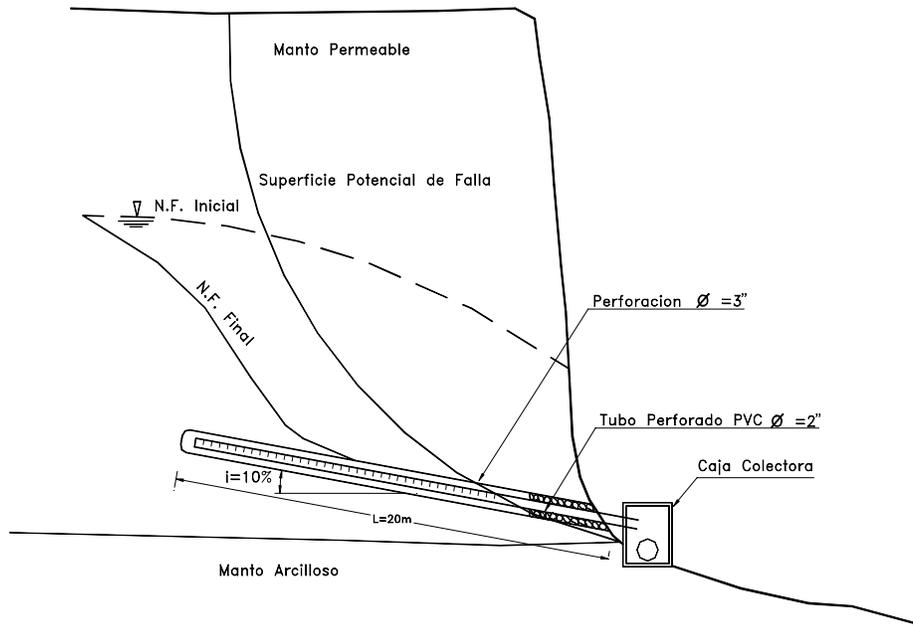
Esquema general de colocación de un subdren de penetración.
